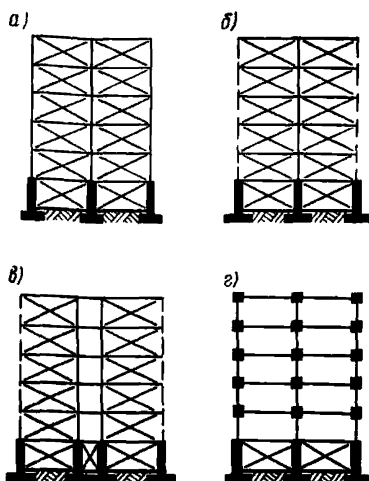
Схемы поперечных разрезов панельных зданий
